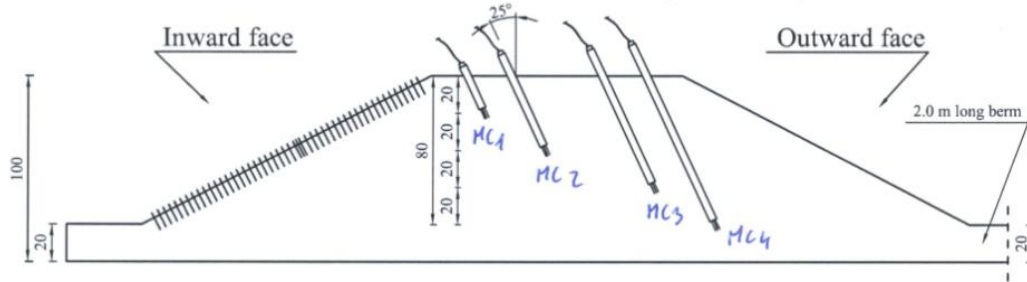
Vista en alzado del terraplén a escala con la profundidad de las sondas ThetraProbe.
